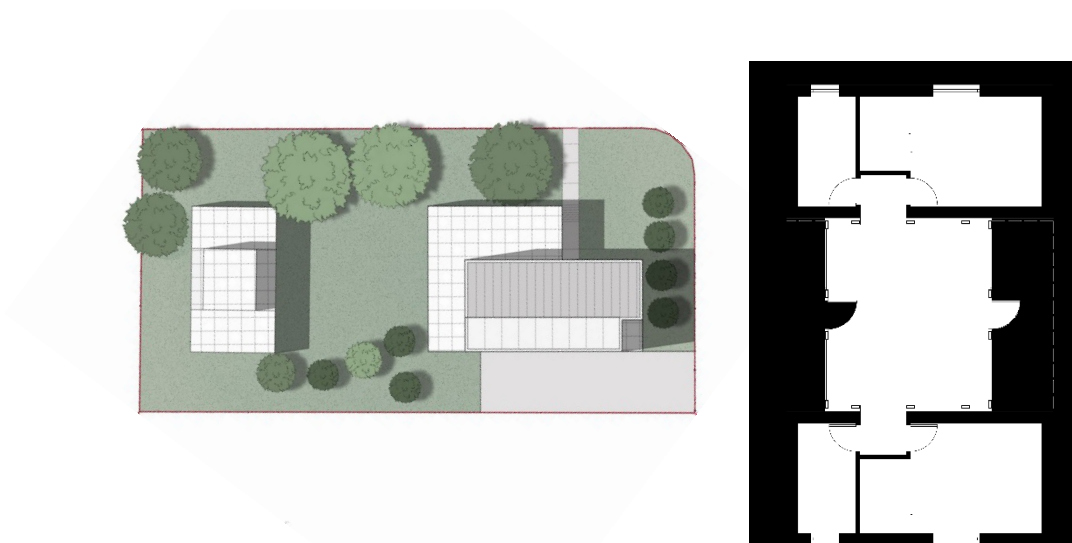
Planivolumetria di progetto e planimetria del nuovo edificio.
